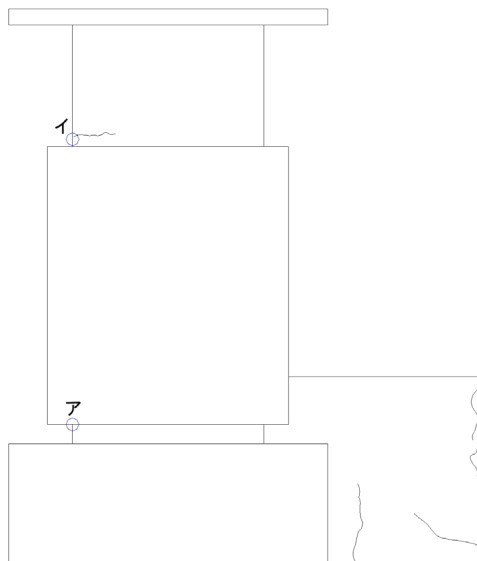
3. 186 柱ひび割れ幅測定位置 (試験体 A-1 正載荷)
